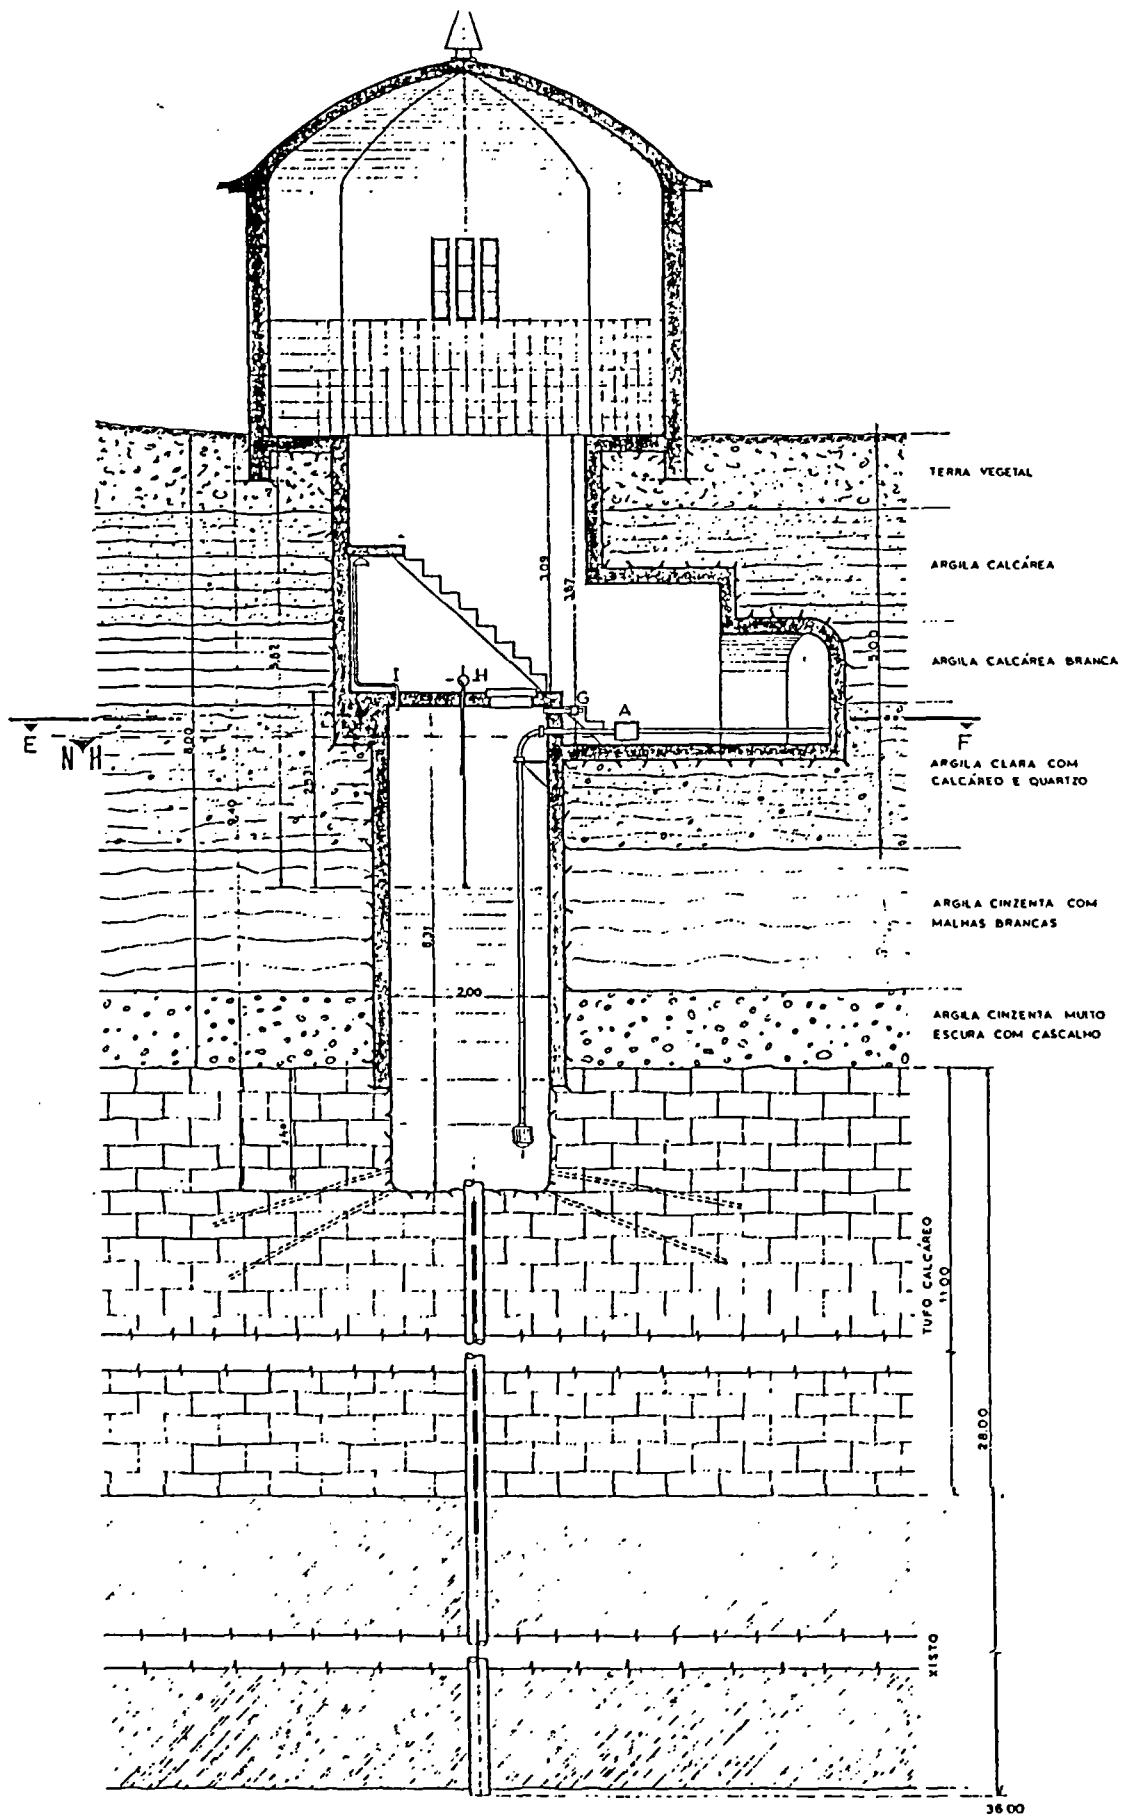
Coupe et équipement du puits n° 6 - Pisos.
